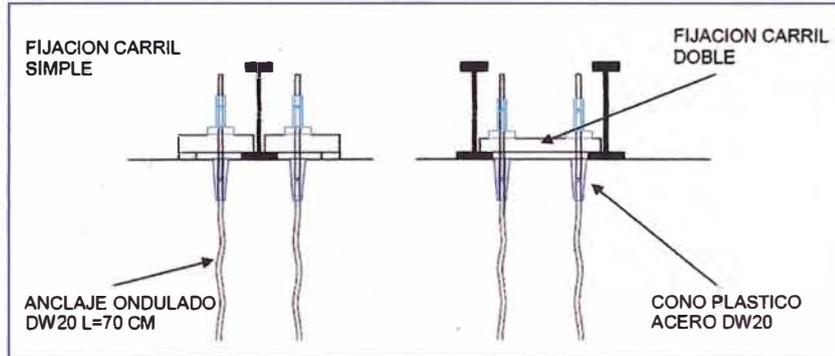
Vista Sección de fijación de los carriles - Fuente: Elaboración Propia
